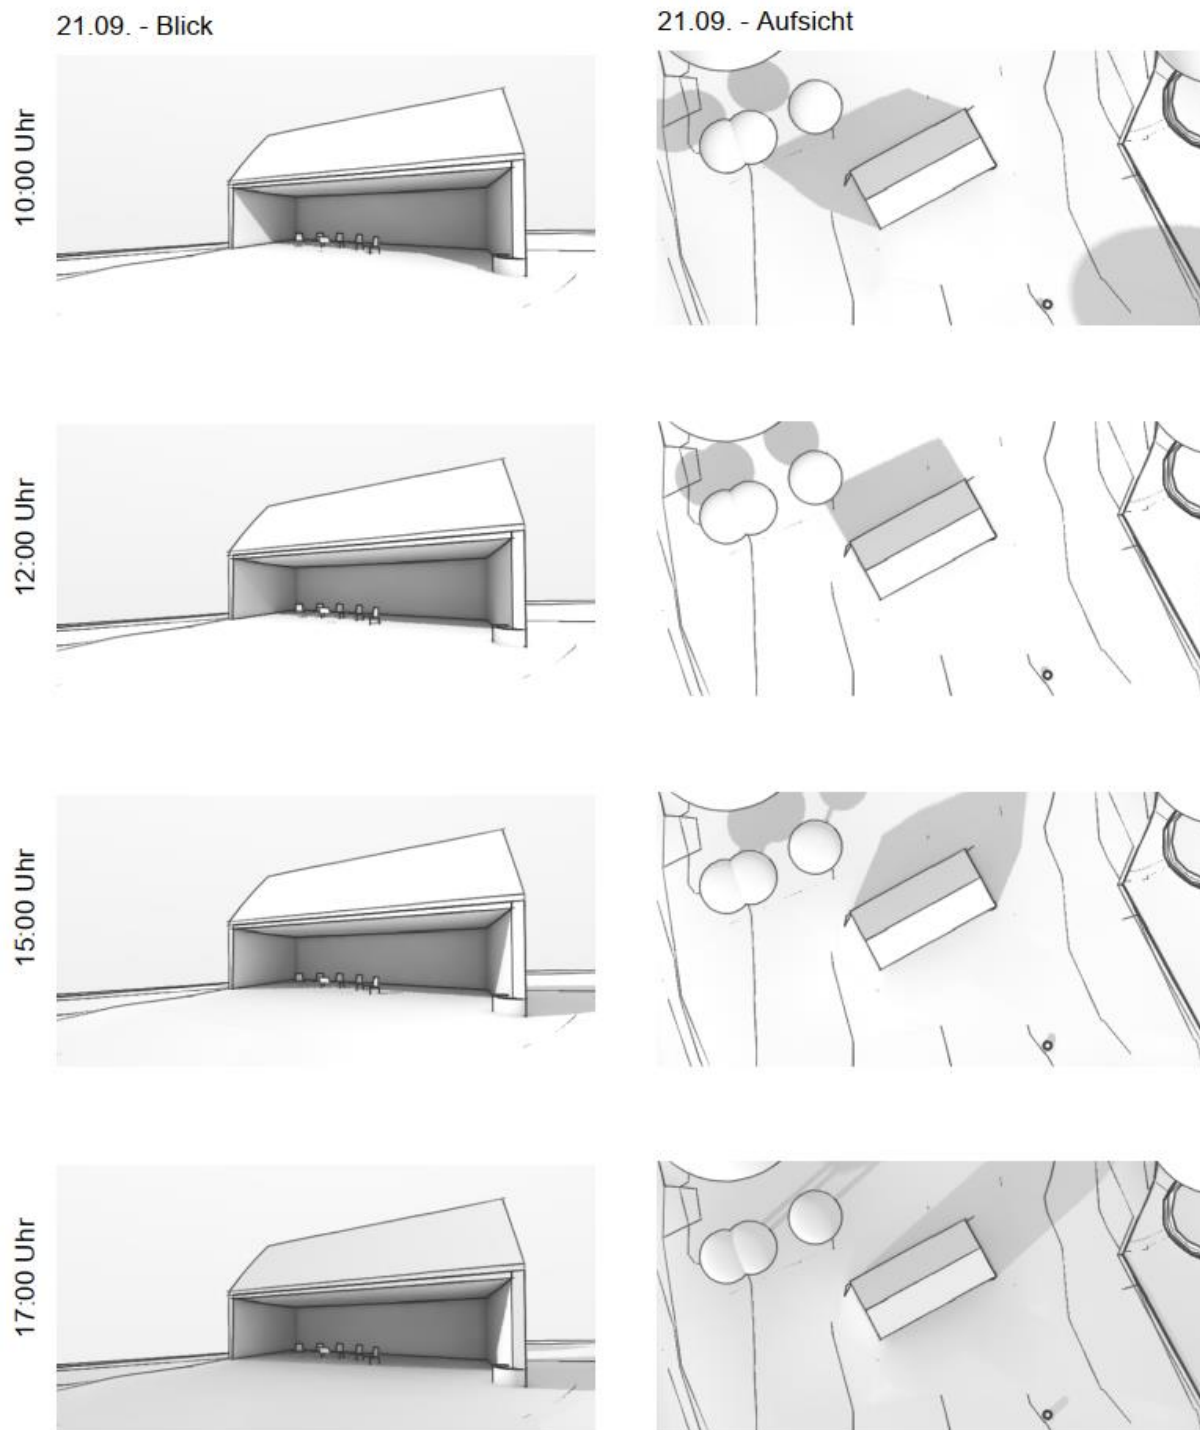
Sonnenstudie, Tag- Nachtgleiche, Planstatt Senner, September 2023
